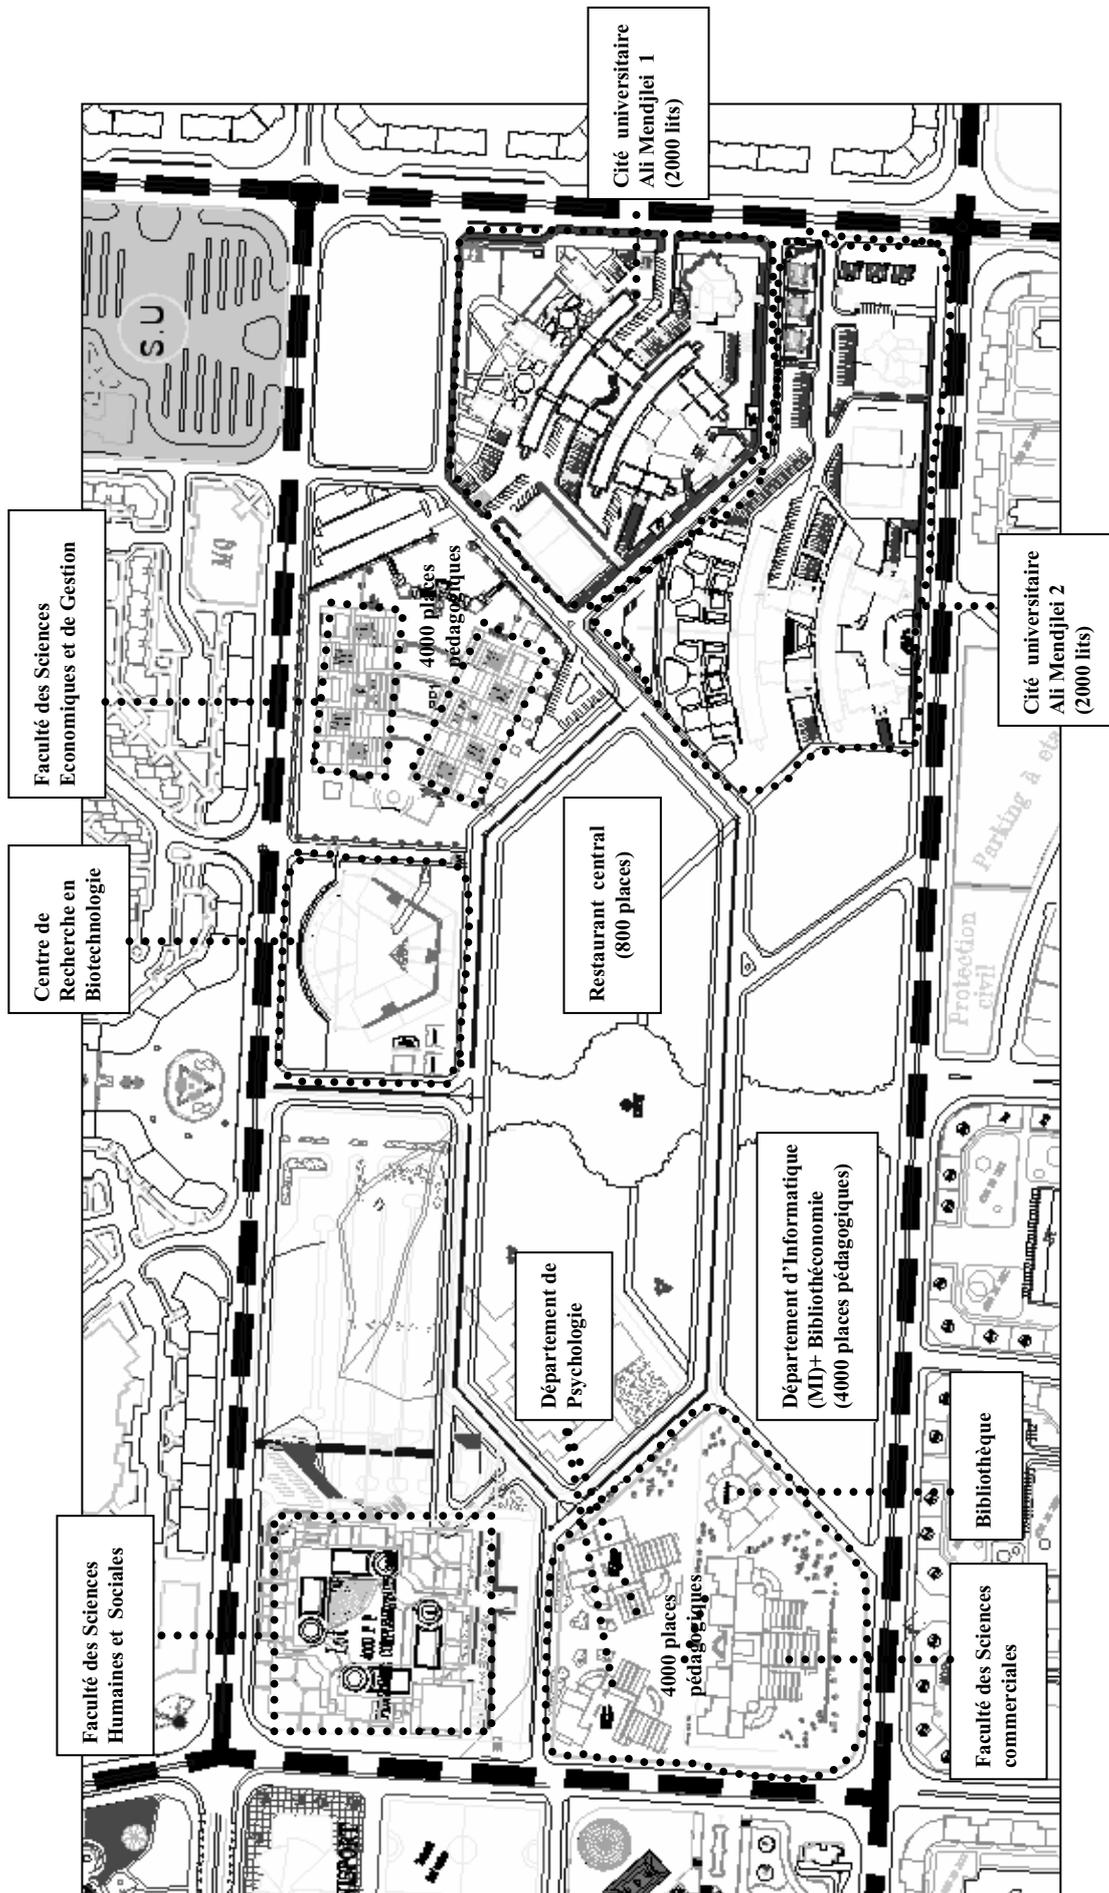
Plan du pôle universitaire de la ville nouvelle -UV.3-
